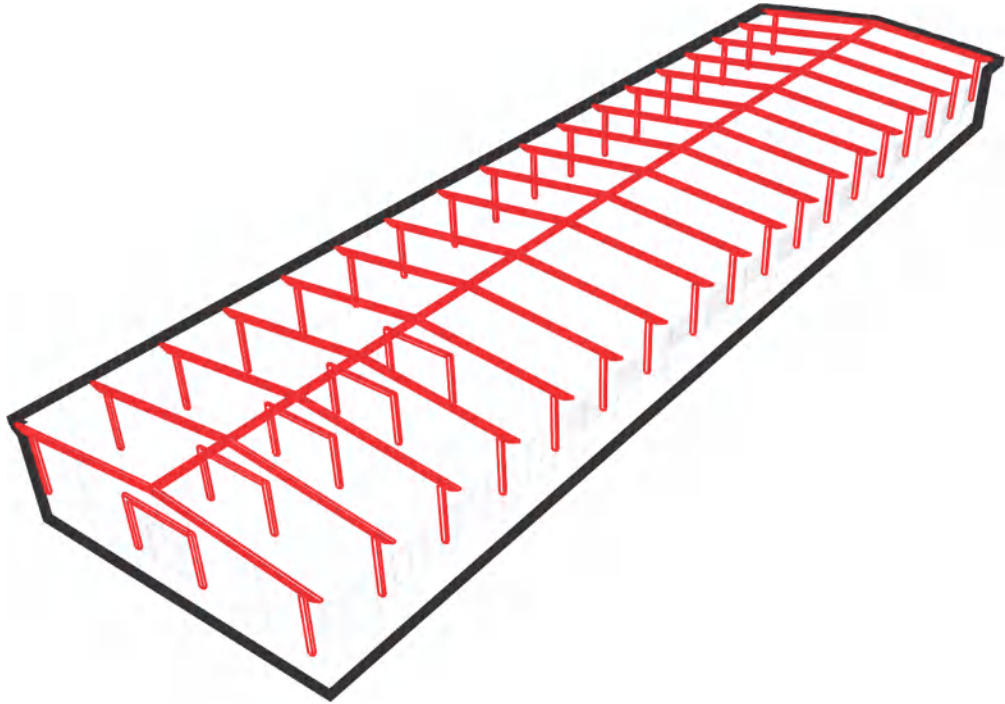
ESTRUTURA DO BLOCO DE AULAS
